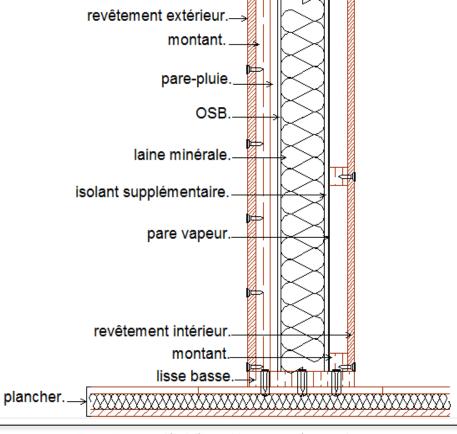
coupe détail d'assemblage mur extérieur en bois. Source : auteurs.
